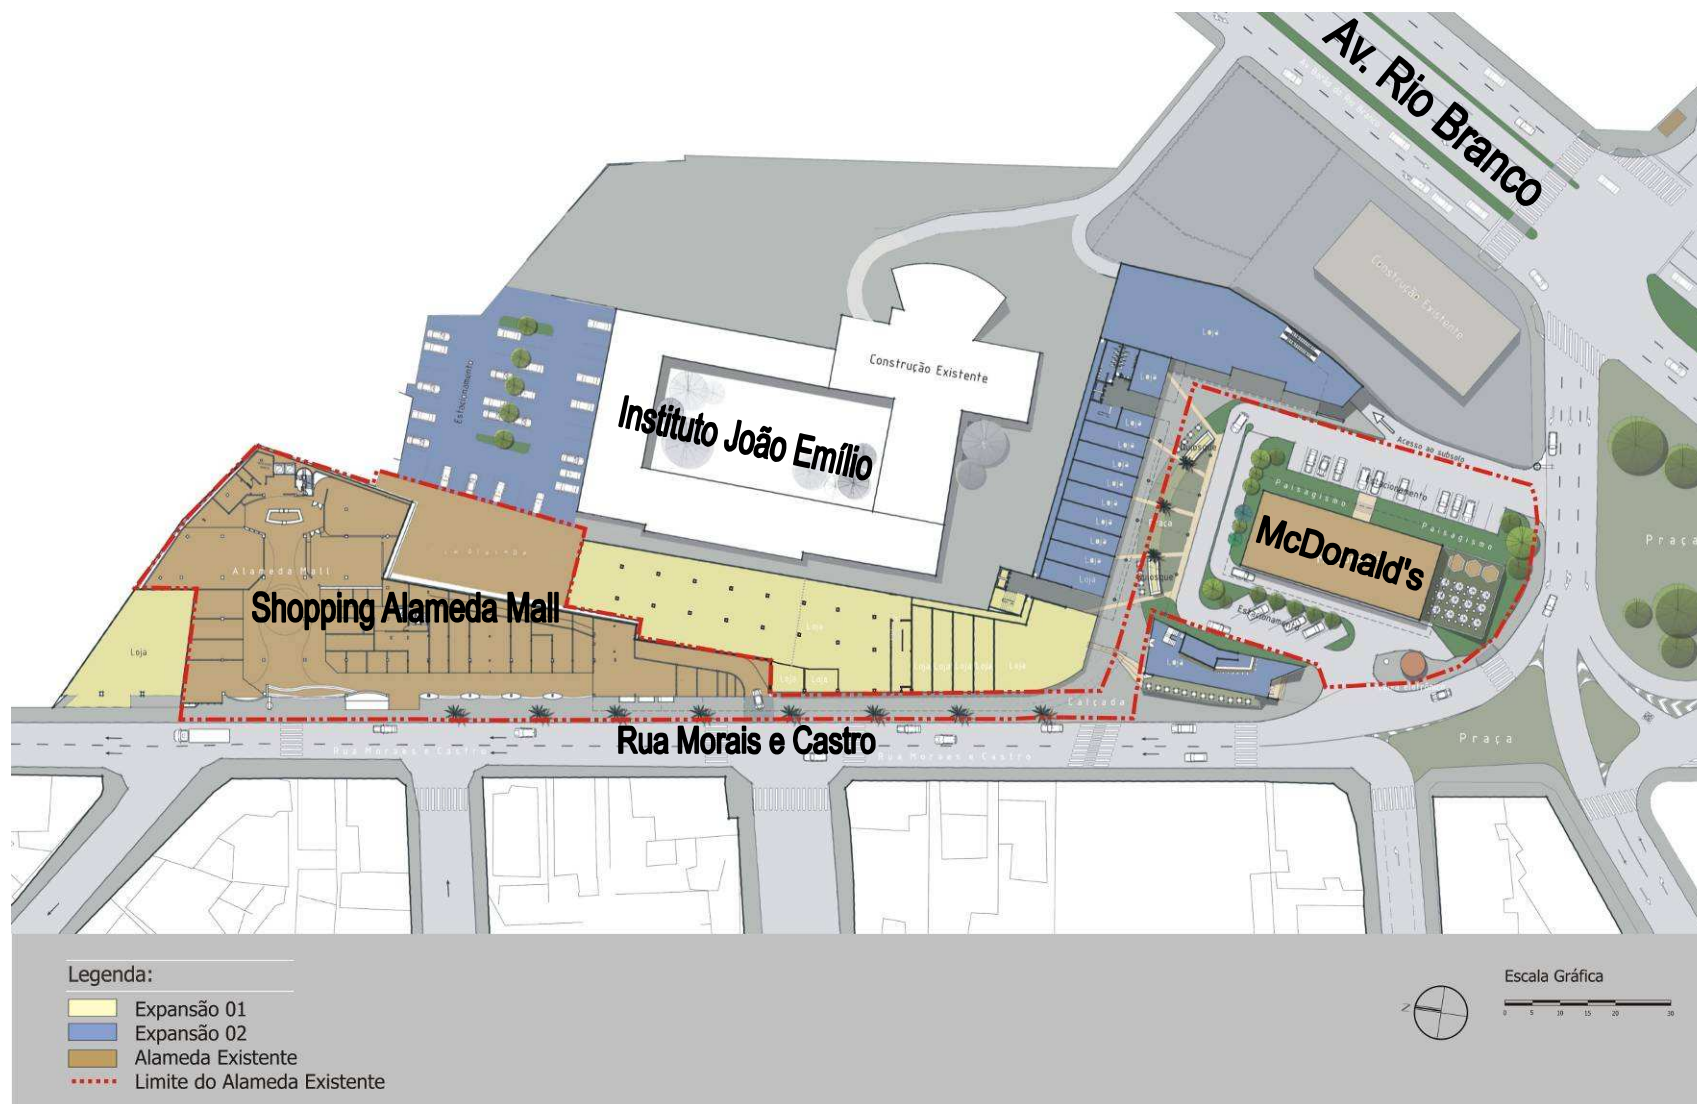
Planta mostrando o McDonald's e o Shopping Alameda, com fases de construção.
